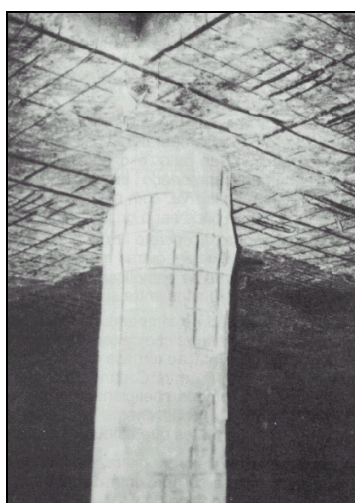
Incêndio em uma estrutura de concreto (Cánovas, 1988): pilar rompido por compressão devido à diminuição da resistência; concreto desagregado e armadura exposta na face inferior da laje.
